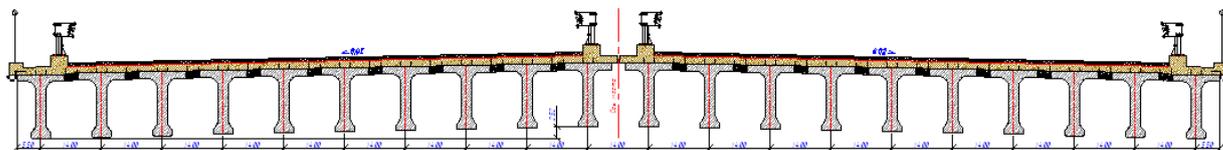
Поперечное сечение пролетного строения железобетонного балочного моста.
